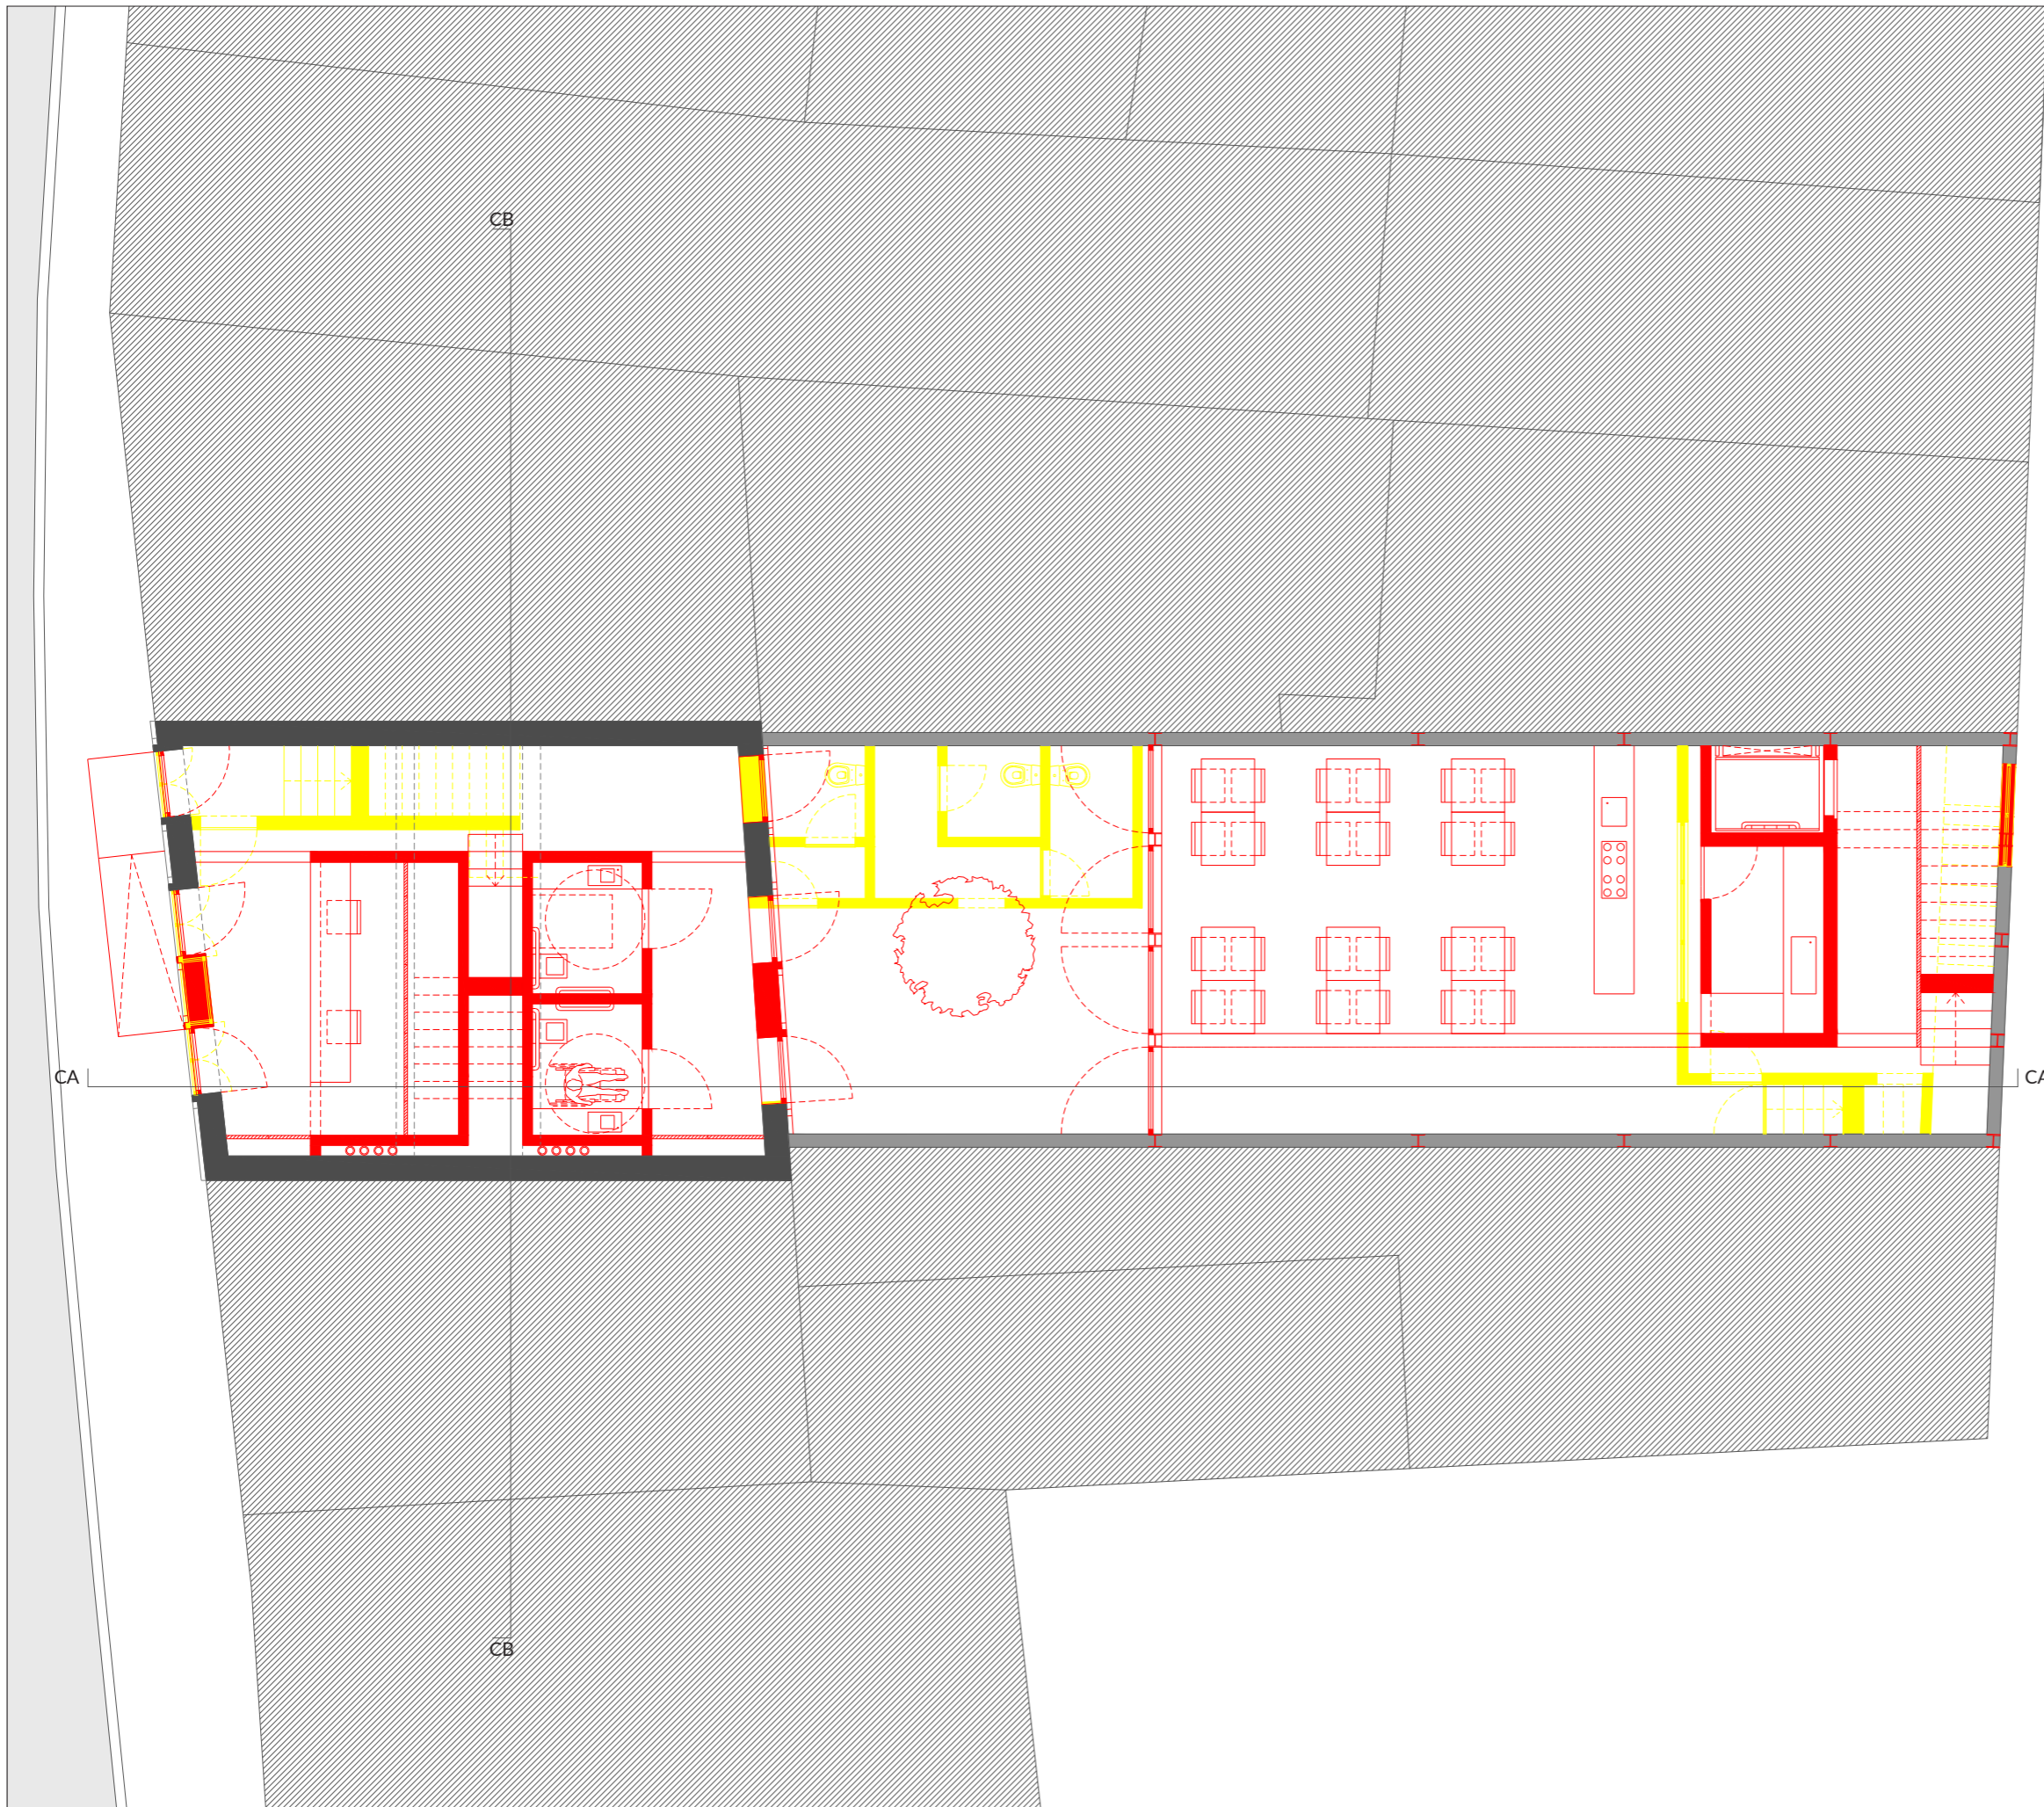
Planta do piso 1 | Vermelhos e amarelos
